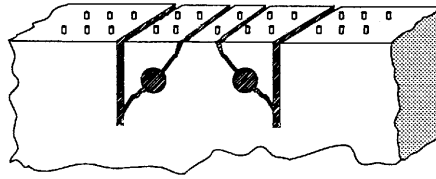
Presswerkzeuge zu nahe an den Einschnitten
